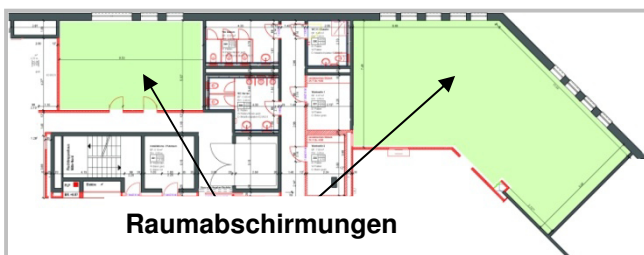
Grundriss mit zu schirmenden Räumen
